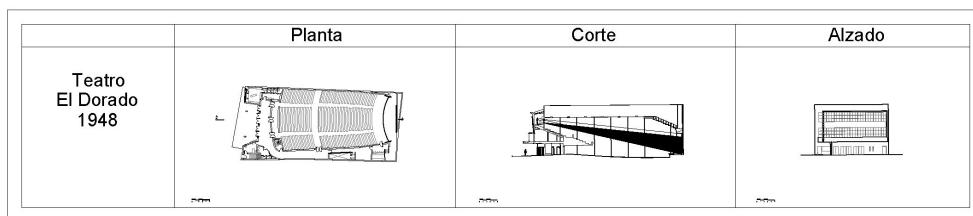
Teatro El Dorado en planta, corte y alzado.
